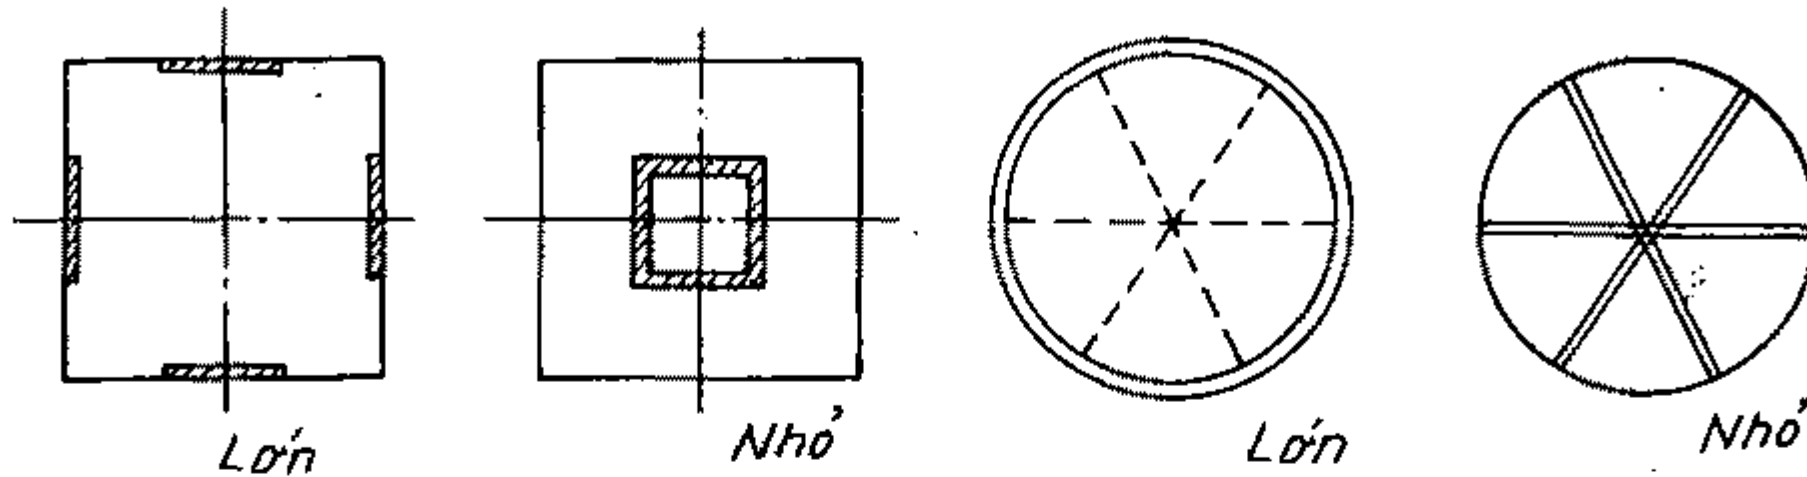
Dạng mặt bằng và hình khối tòa nhà
